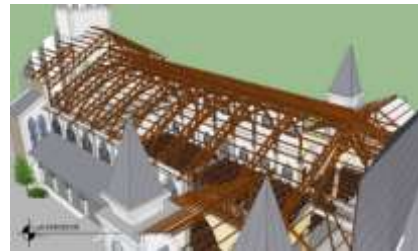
Konsep struktur dan konstruksi bangunan gereja
